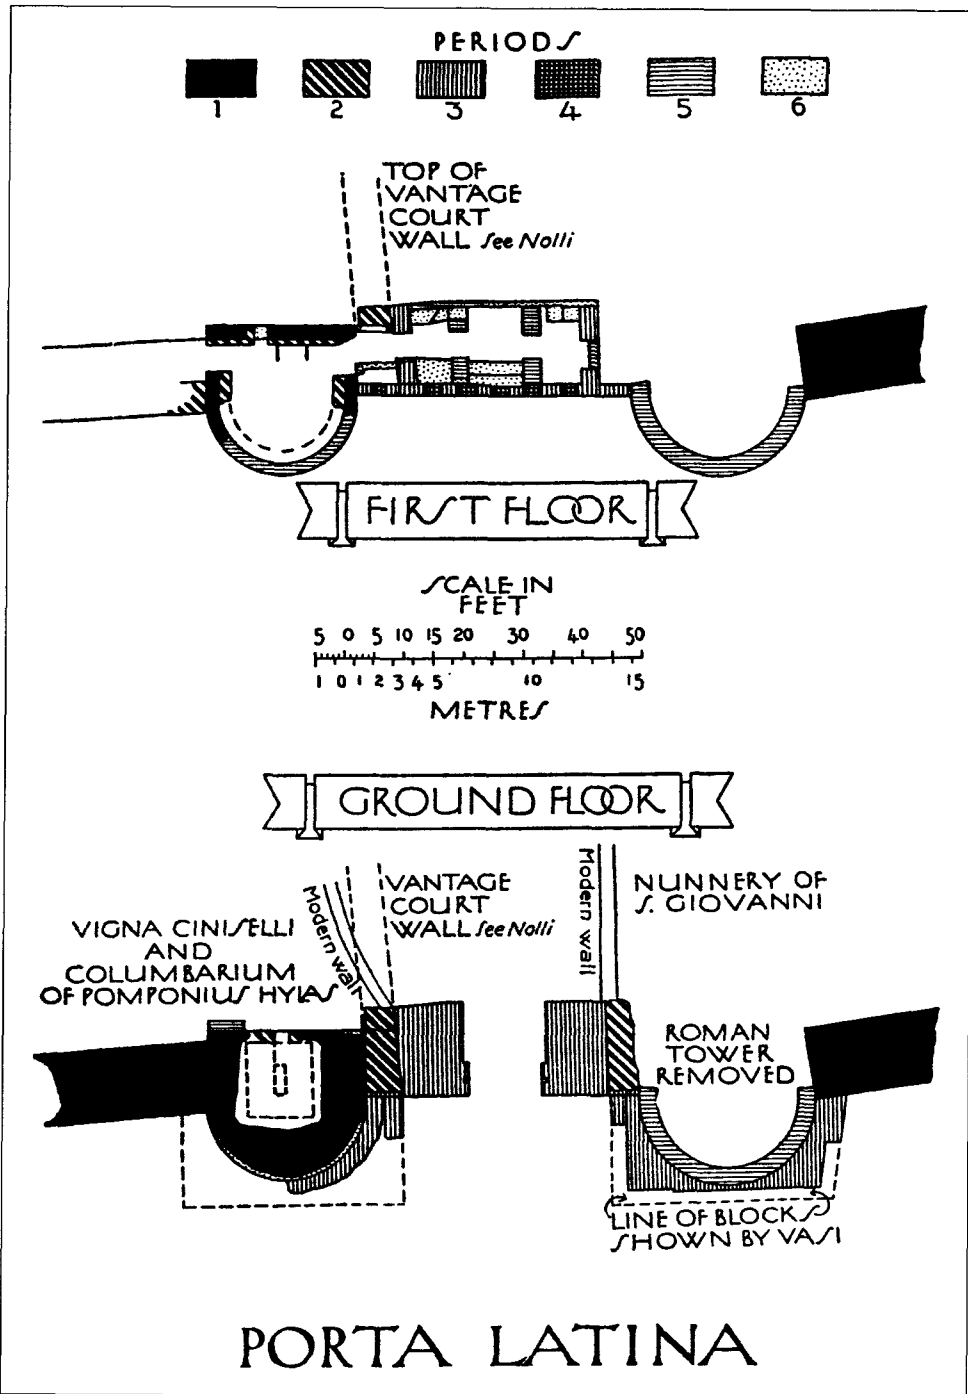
Pianta e fasi costruttive di Porta Latina. Da Richmond, 1930: fig. 17.
